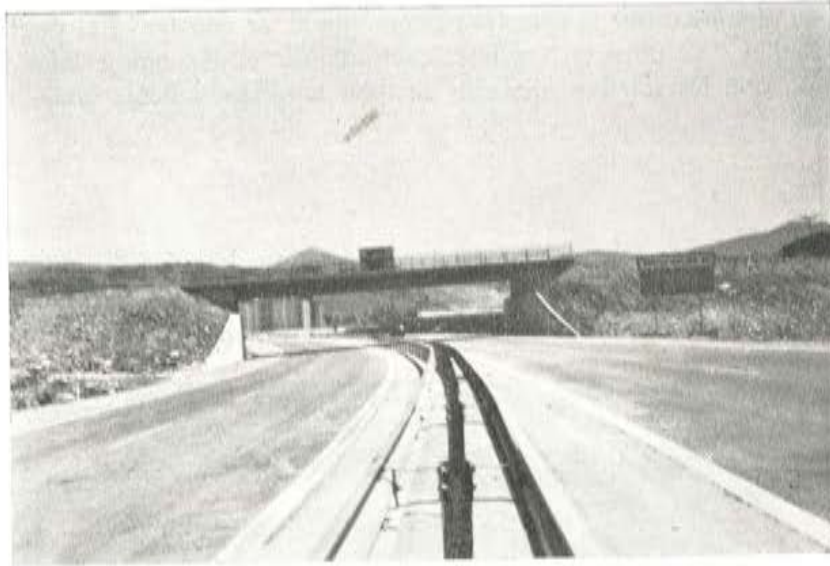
Paso sobre autopista. Losa apoyada sobre macizos de tierra armada.
